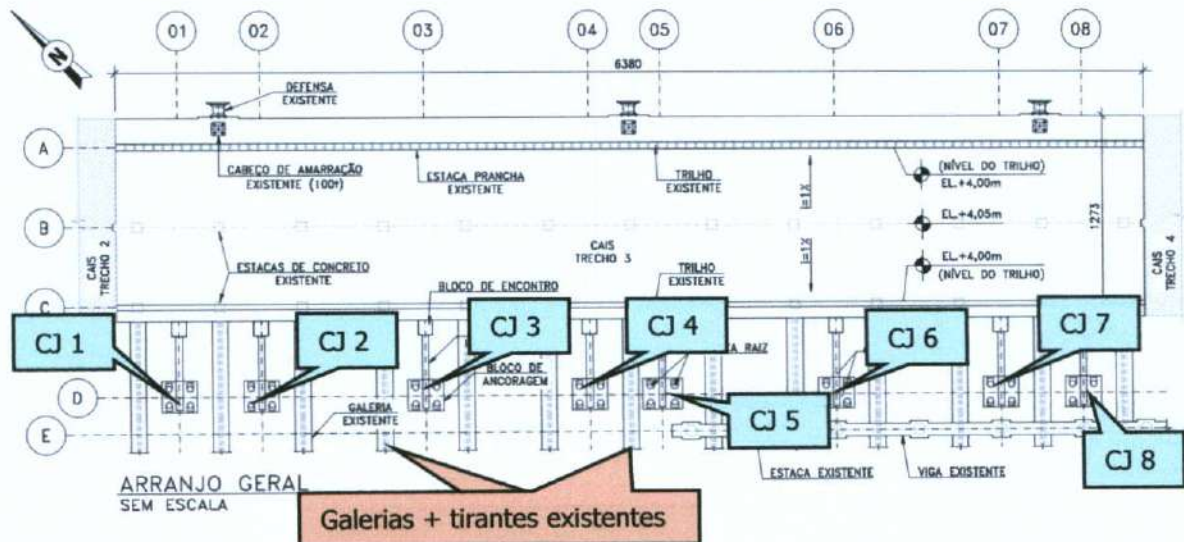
Novos sistemas de ancoragem – planta (segmento 3)
